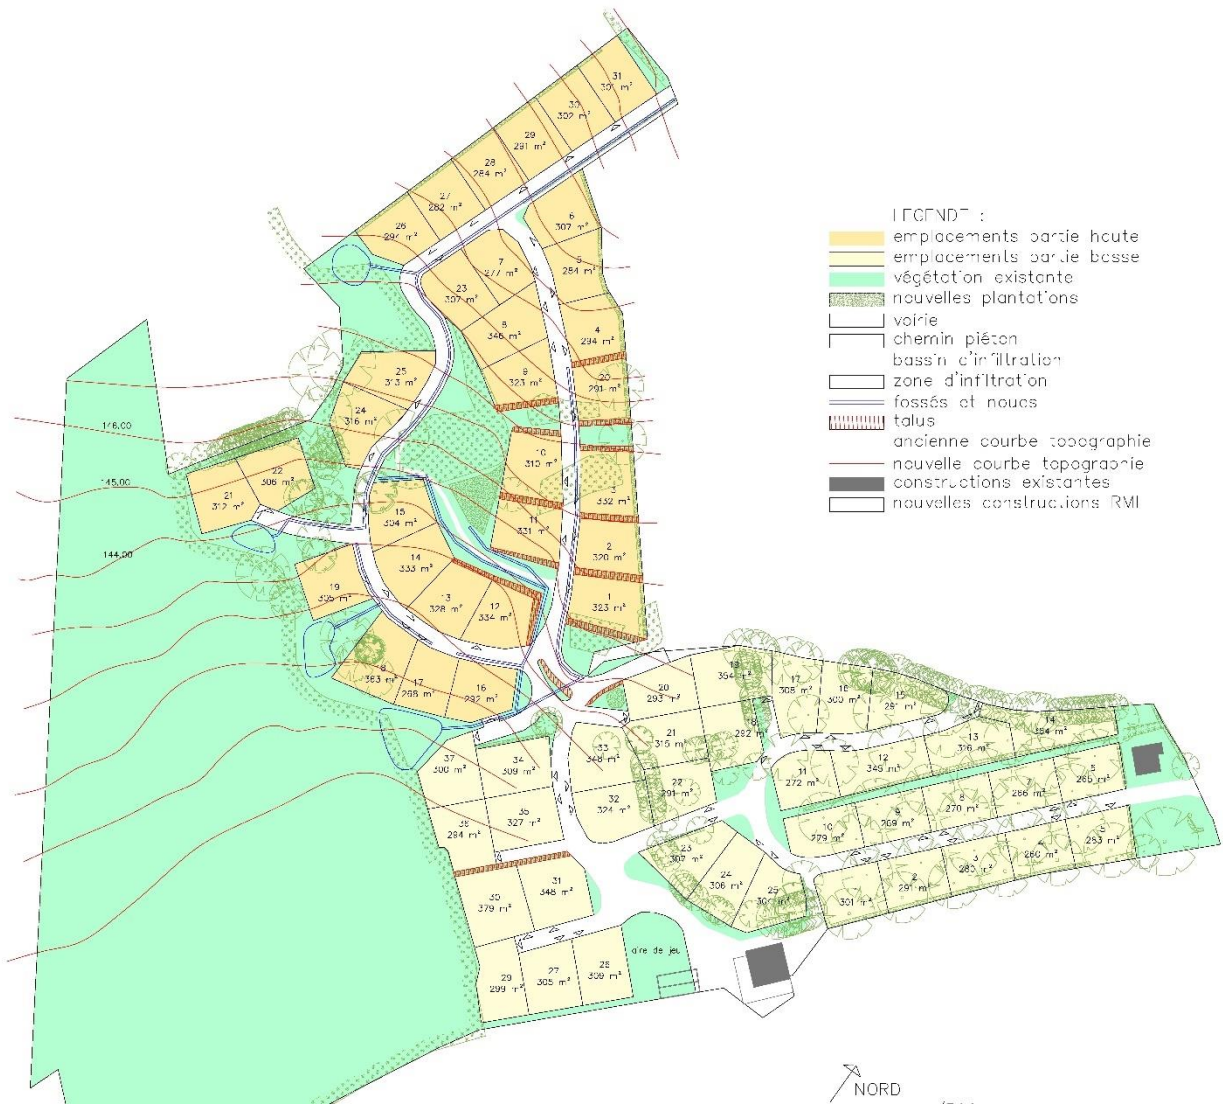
Plan d'aménagement : solution C (non retenue - base du plan final)
